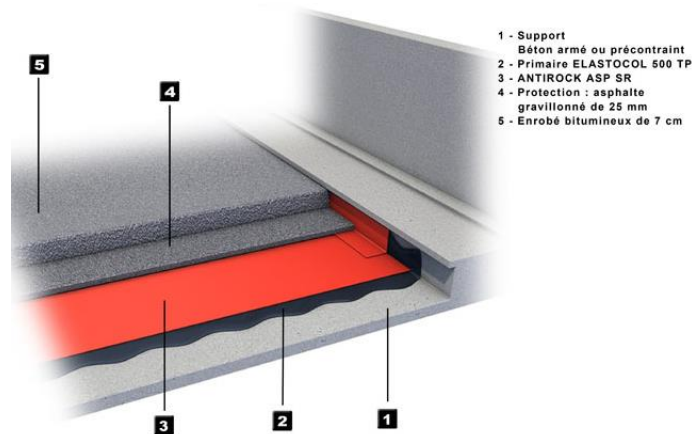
Illustration de l'étanchéité à mettre en œuvre sur l'ouvrage
